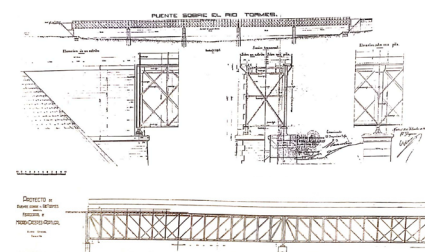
Planos del puente del Pradillo. J. M. del Villar. 1927
